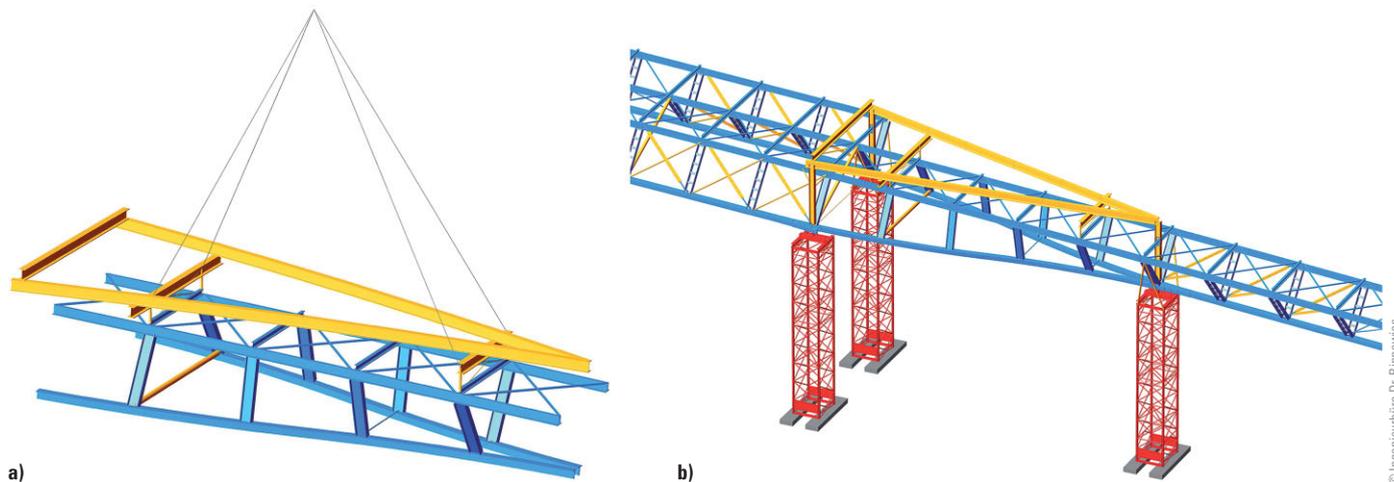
a) Am Kran hängende Hubtraverse für Mittelbauteile (hier: Sub-Bauphase 3); b) Auf Rüsttürmen abgestellte Hubtraverse für Mittelbauteile (hier: Sub-Bauphase 3)
